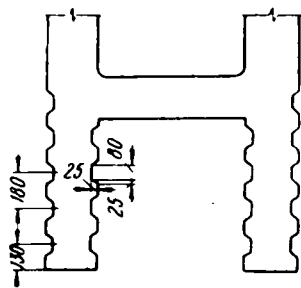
Деталь концов двухветвевых колонн для обеспечения их заделки в фундаментах
